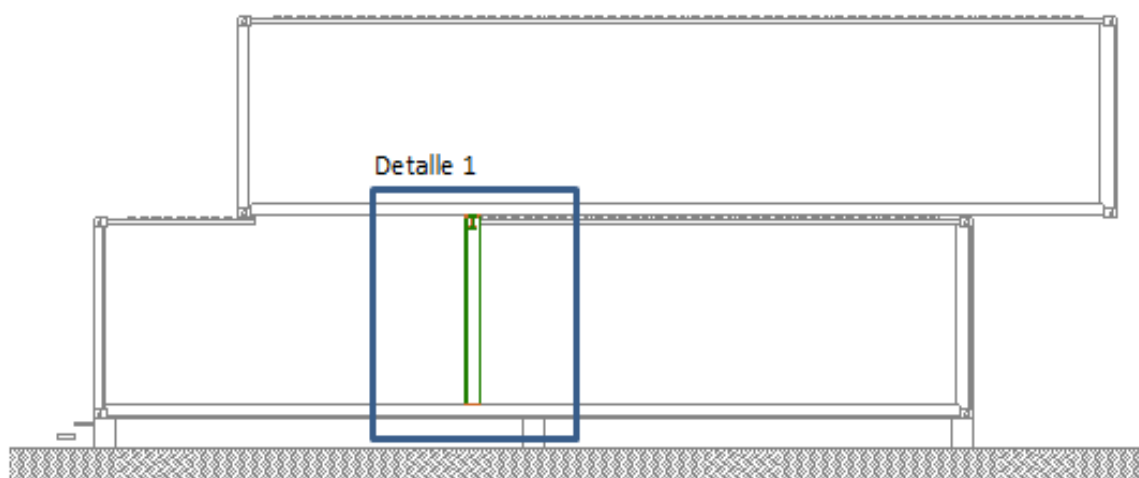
Corte longitudinal del refuerzo vertical (IPE200).
